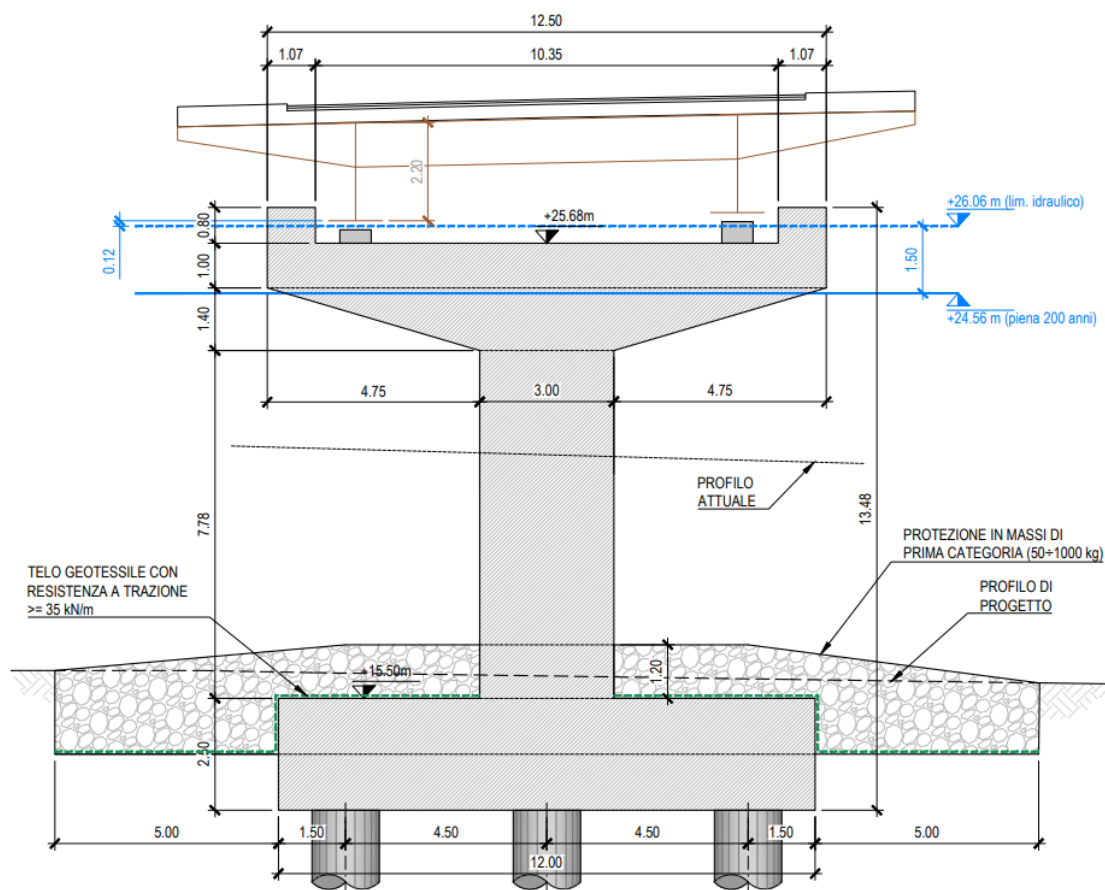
Sezione di una pila del ponte sul torrente Montone
